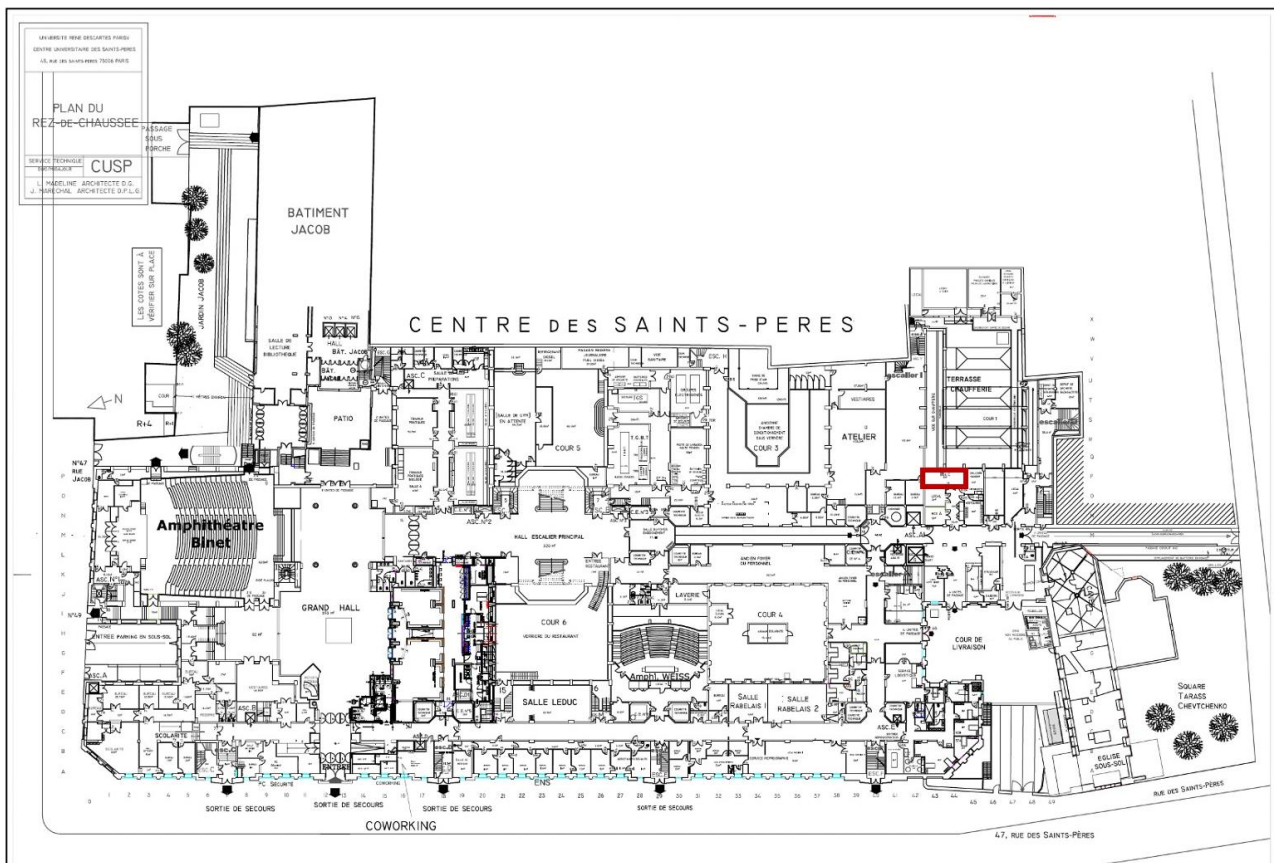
Plan du Rez-de-Chaussée du Centre des Saints Pères
